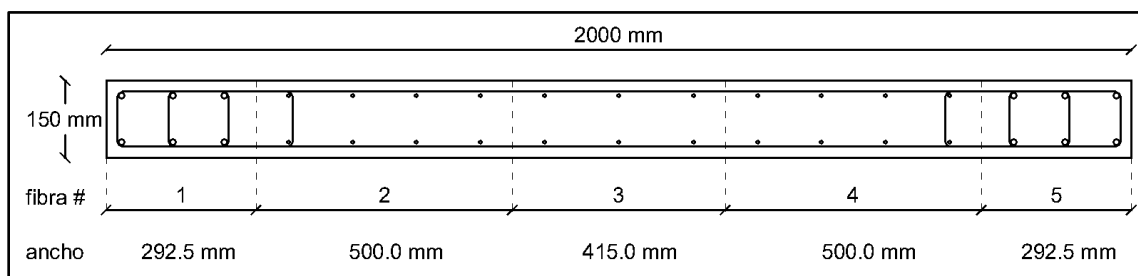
Discretización de la sección transversal del muro WSH6 en 5 macrofibras para el MVLEM y el SFI-MVLEM.
